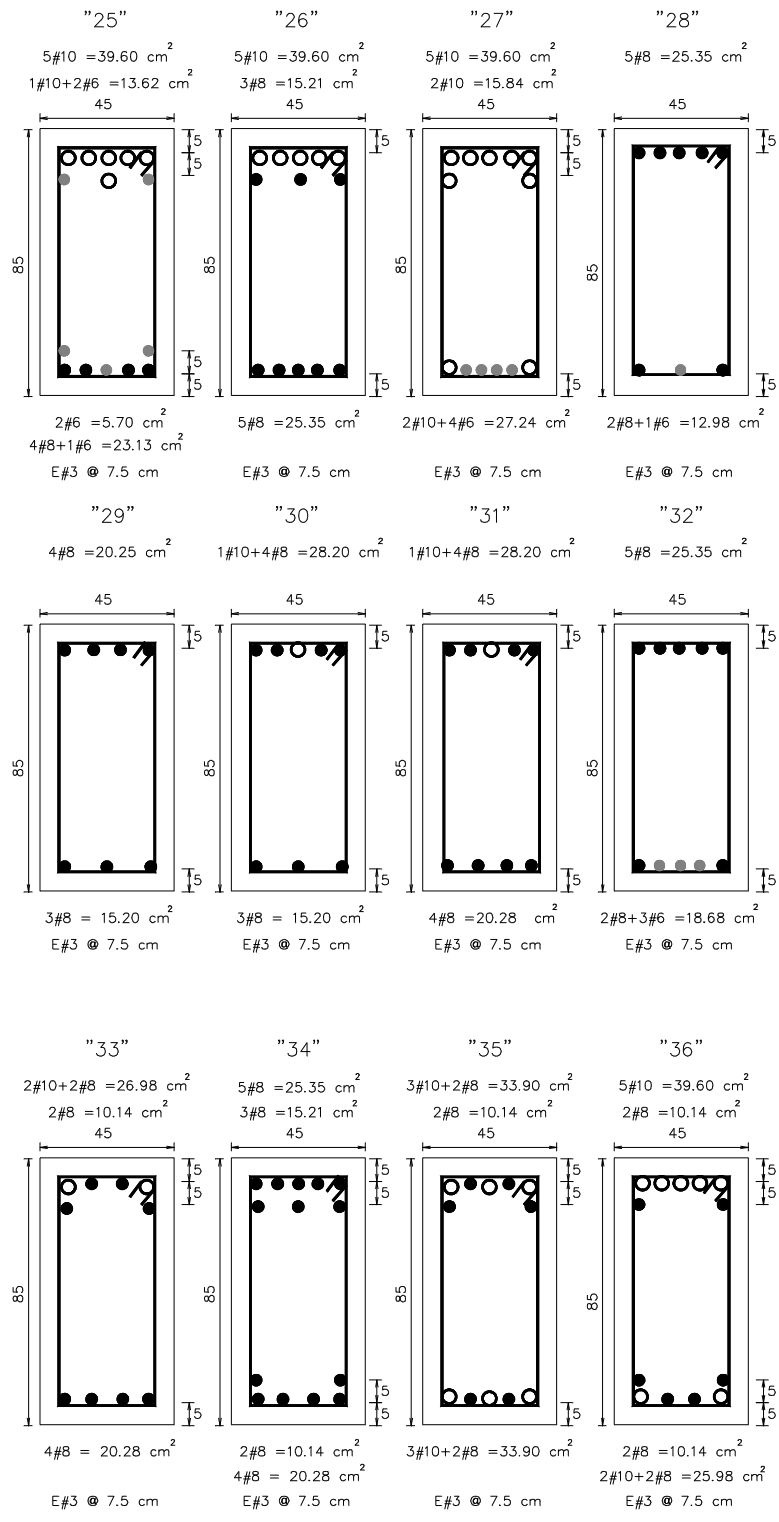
Tipos de armados propuestos para los extremos de las vigas del eje 2, estructuras de 17 niveles diseñadas en zona III (RDF-93 y RDF-04)
